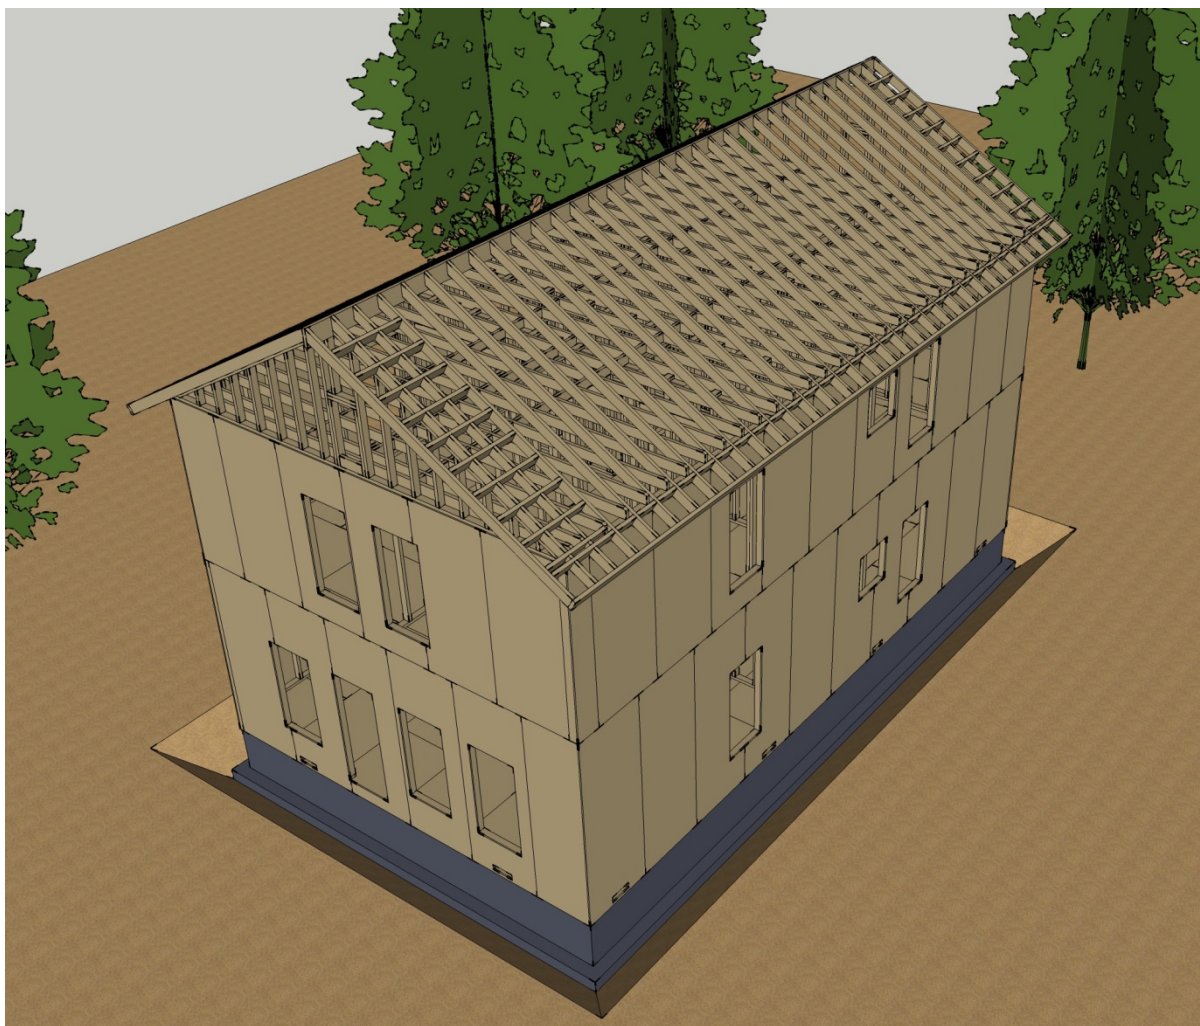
Montagem do forro estrutural das paredes no piso elevado.
